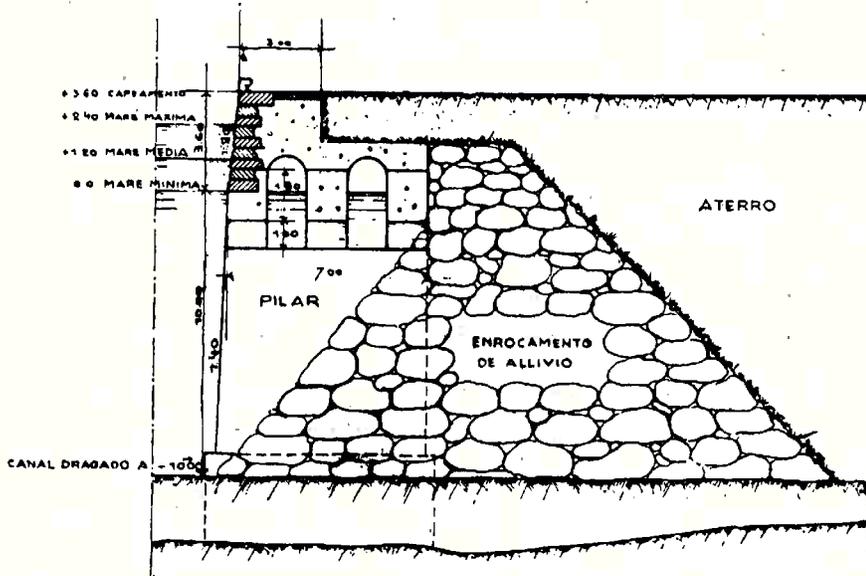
Perfil de arcadas do segundo trecho de muralha do cais do porto do Rio de Janeiro.
